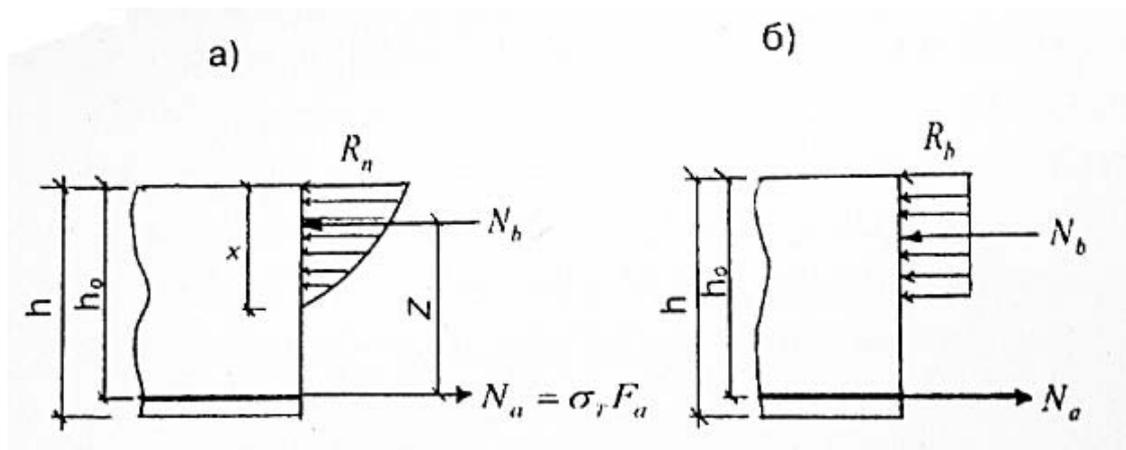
Схема внутренних усилий в нормальном сечении изгибаемого железобетонного элемента при расчёте: а – по разрушающим нагрузкам; б – по предельным состояниям.
